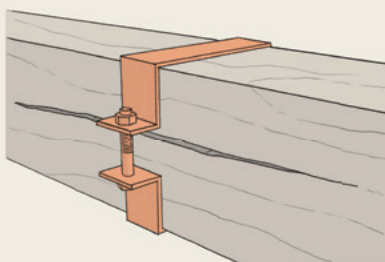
Elemento de reforço para peças de madeira da estrutura principal.
